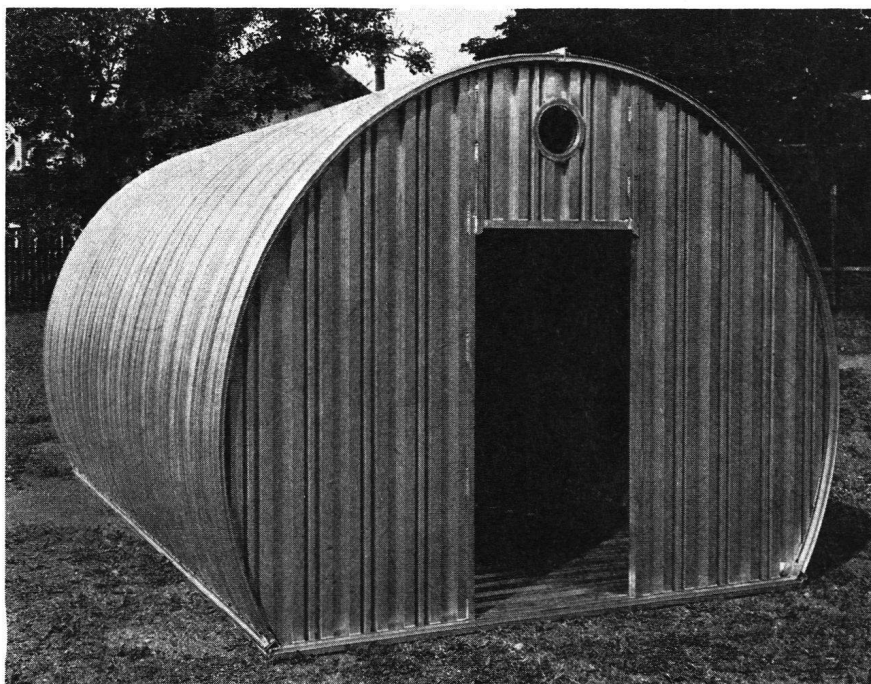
Tunnelunterstand mit Abschlusswand und Durchgangsöffnung.
